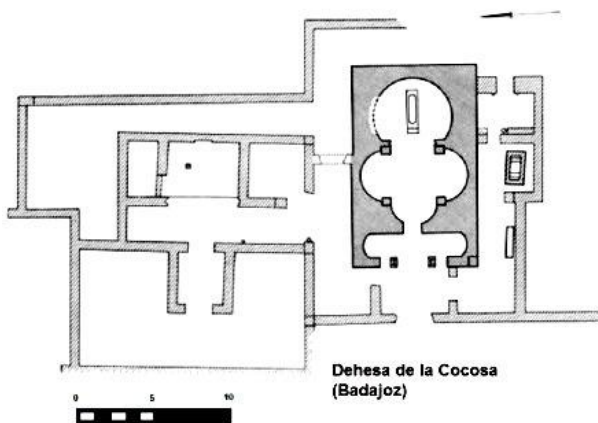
Planta del mausoleo de la villa de la Cocosa.
